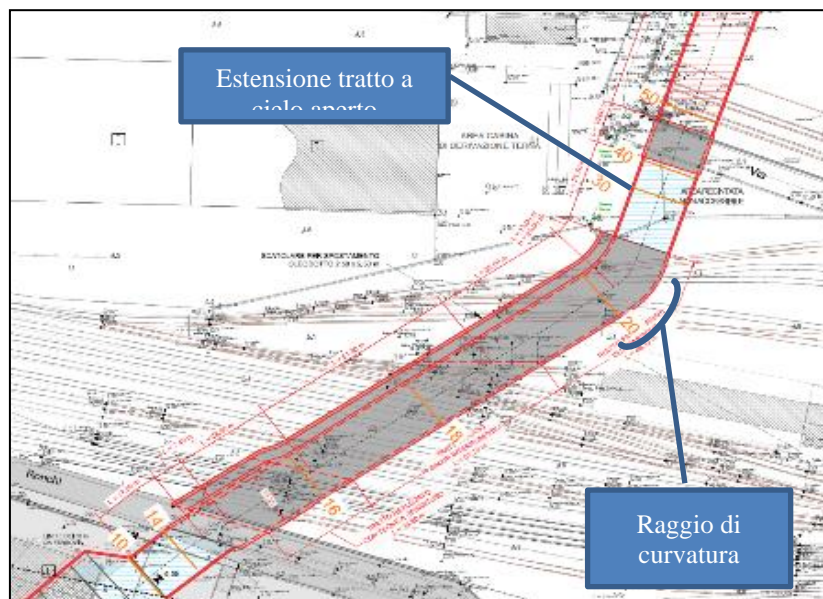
Planimetria progetto preliminare in corrispondenza dell'attraversamento del parco ferroviario
